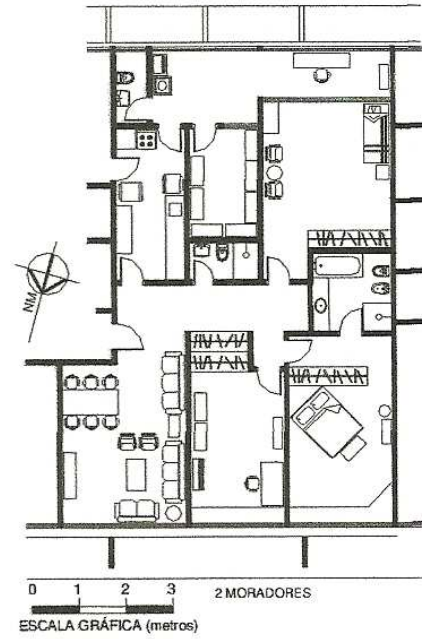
Planta baixa de apartamento do bloco C (Fonte: GALVÃO e ORNSTEIN, 2008, p.6)
